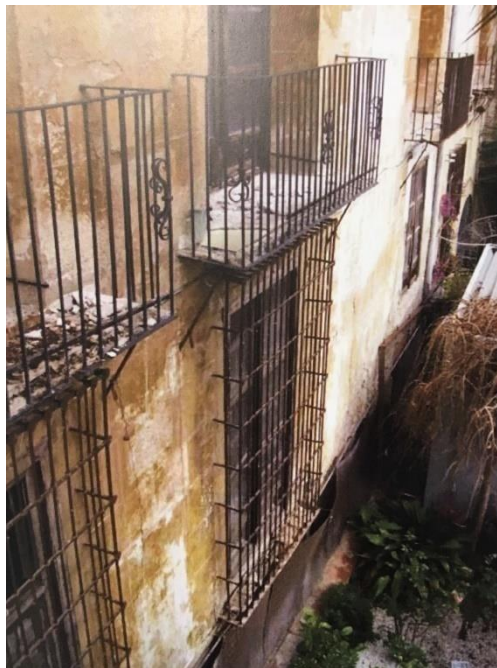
Fachada sur. Fuente: Fernando Aranda Navarro
